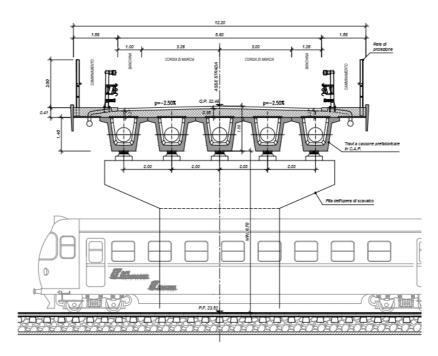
Cavalcaferrovia NW01 – Sezione trasversale impalcato
